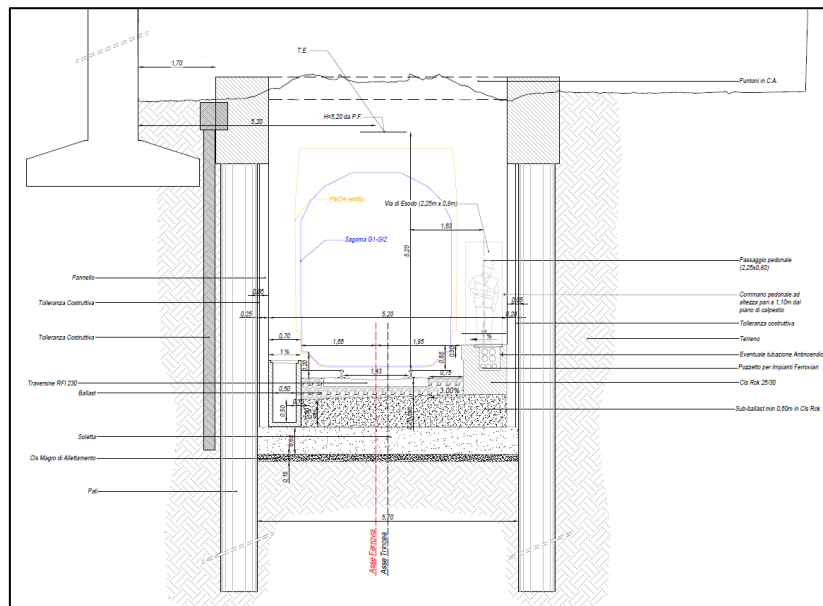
Sezione tipo funzionale sotto autostrada A14 – Tratte T2
